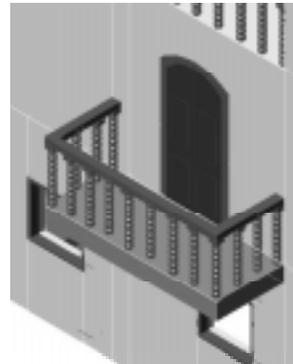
Vivienda Montañesa. Detalle Balcón.
